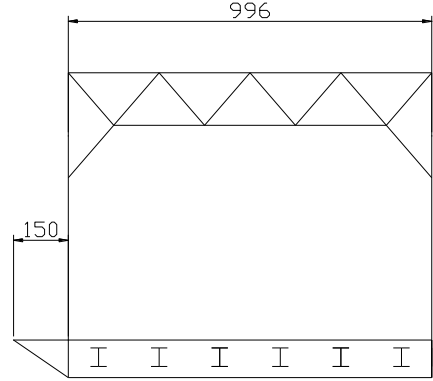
单幅桥梁横向布置示意图 (单位: cm)
